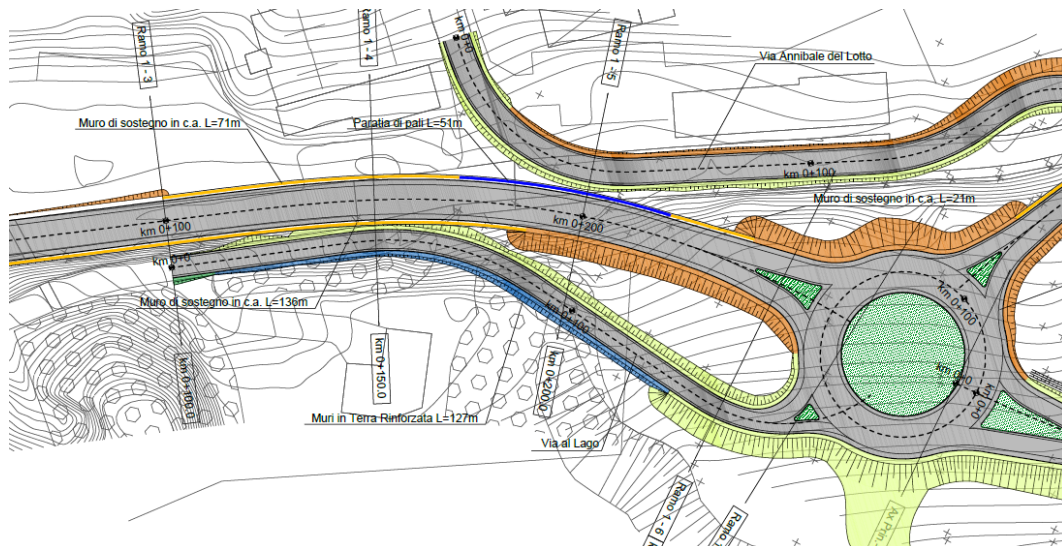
Stralcio planimetrico Ramo 1 del PD senza le fermate Bus
